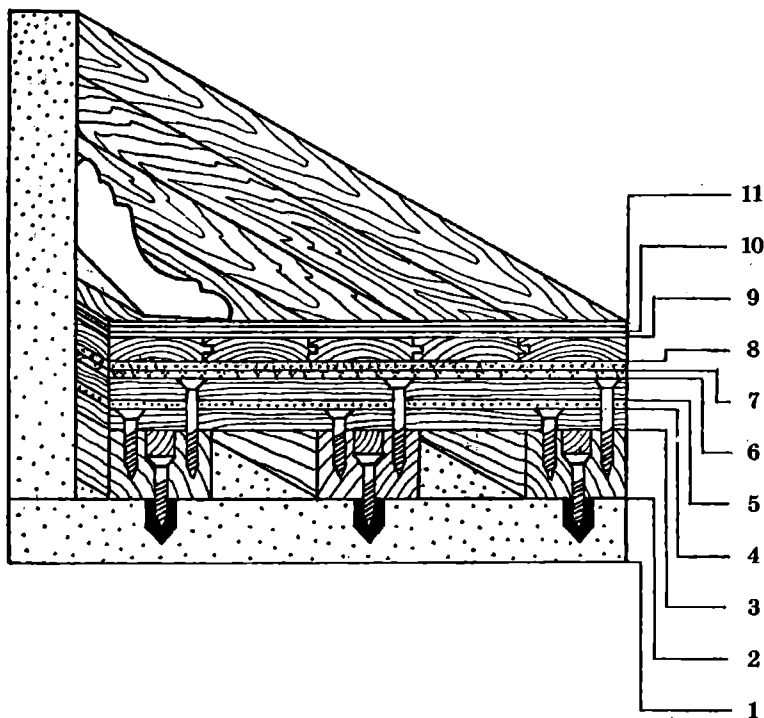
Схема конструктивного решения пола с паркетным покрытием на бетонном перекрытии (со стяжкой) фирмы «Паркет-Холл»:
